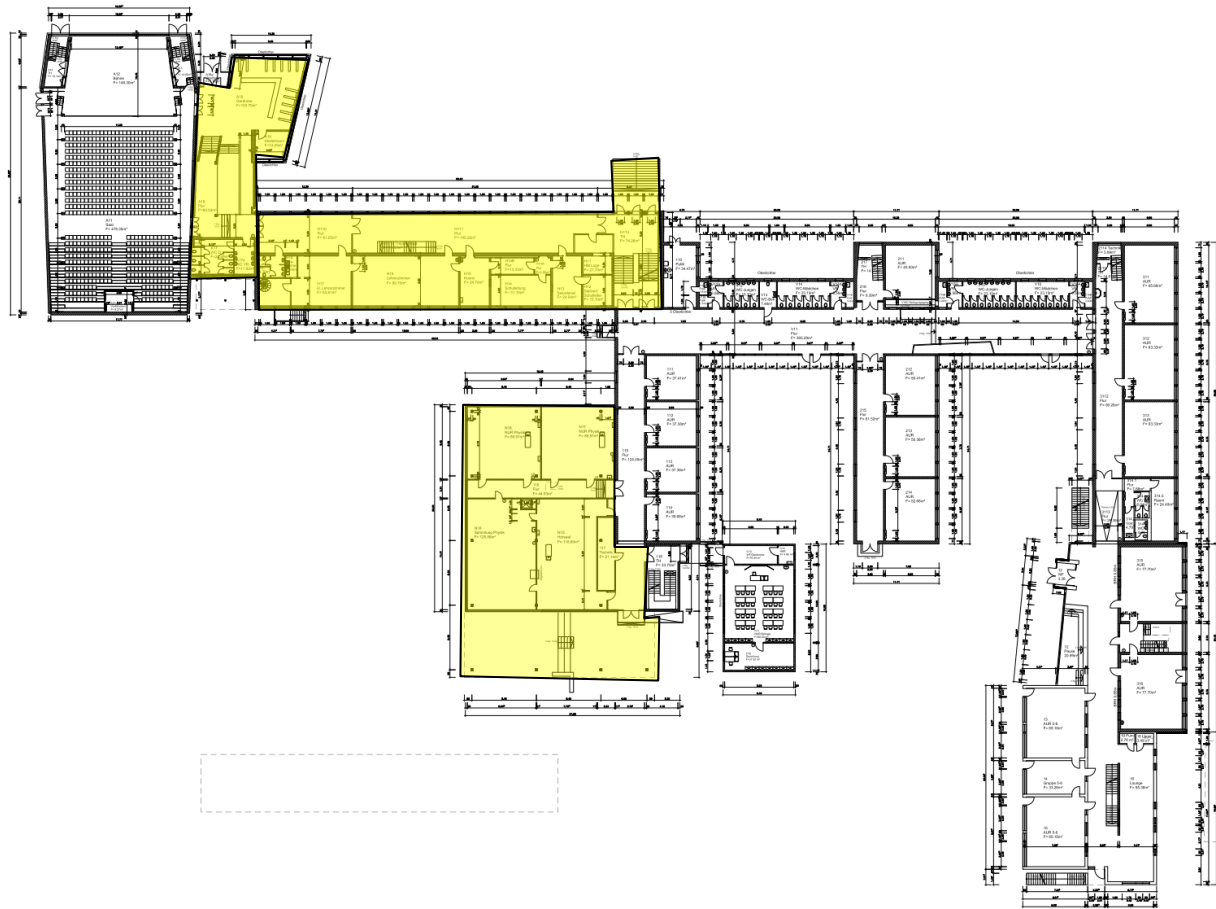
Bestandsplan von 2008 Grundriss EG des Ratsgymnasiums mit Markierung der abzubrechenden Gebäudeteile
